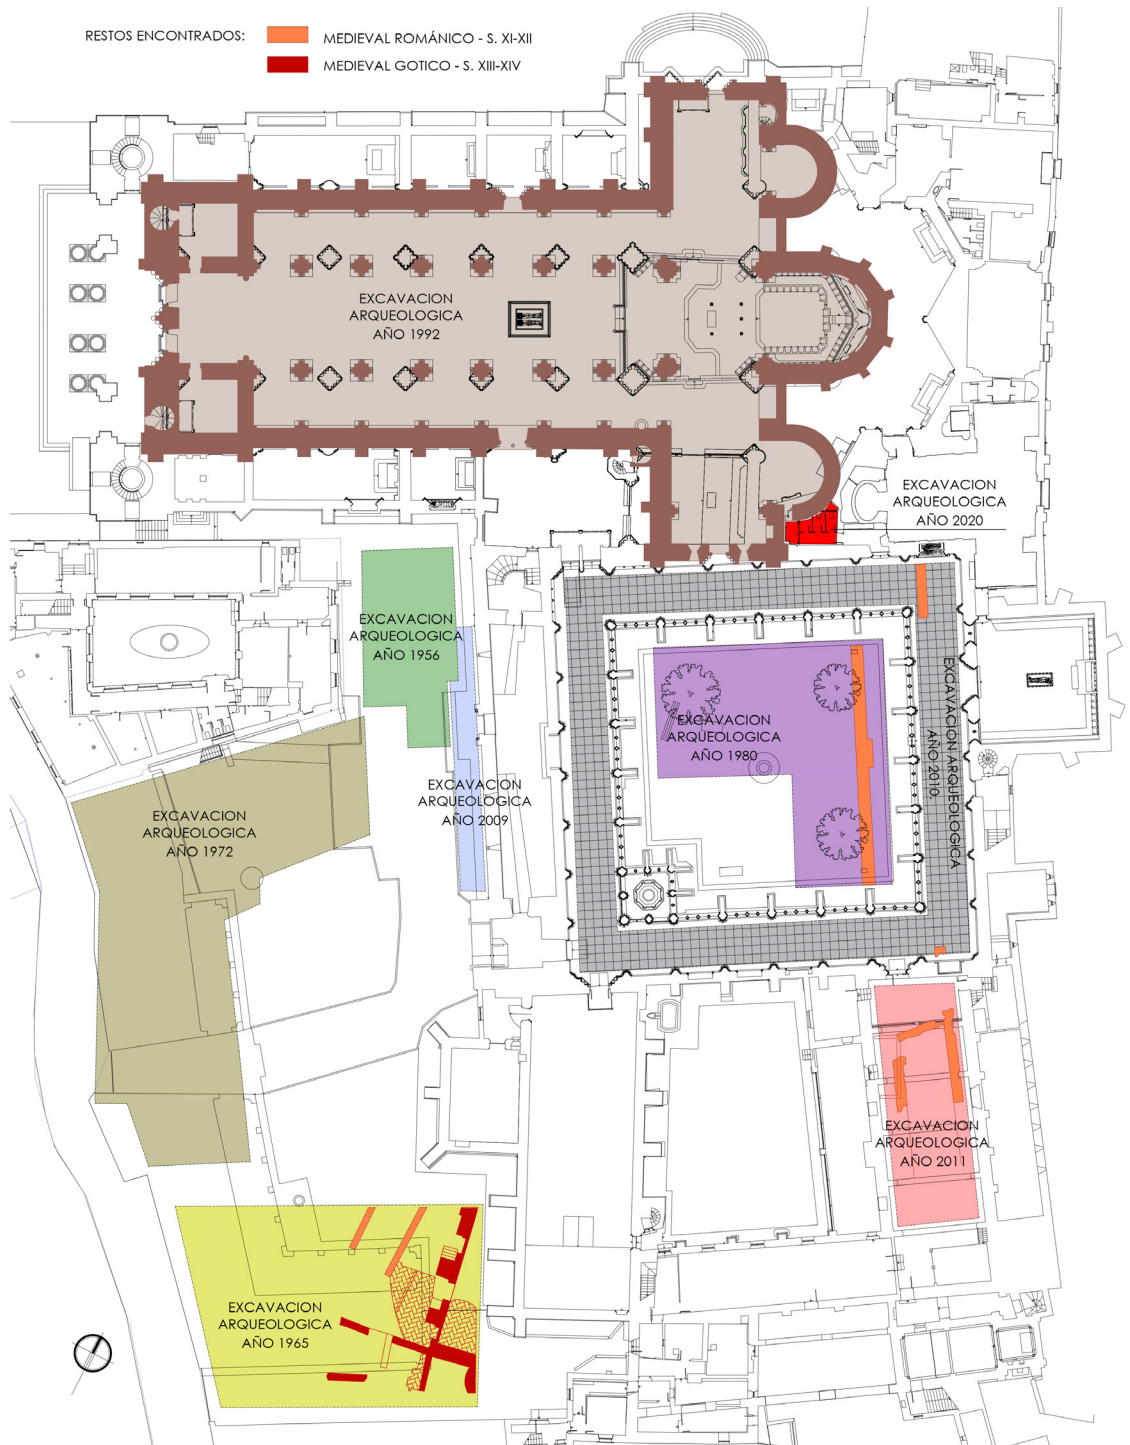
Plano descriptivo de las excavaciones arqueológicas, sobre fondo planimétrico realizado por el estudio Garralda arquitectura.
